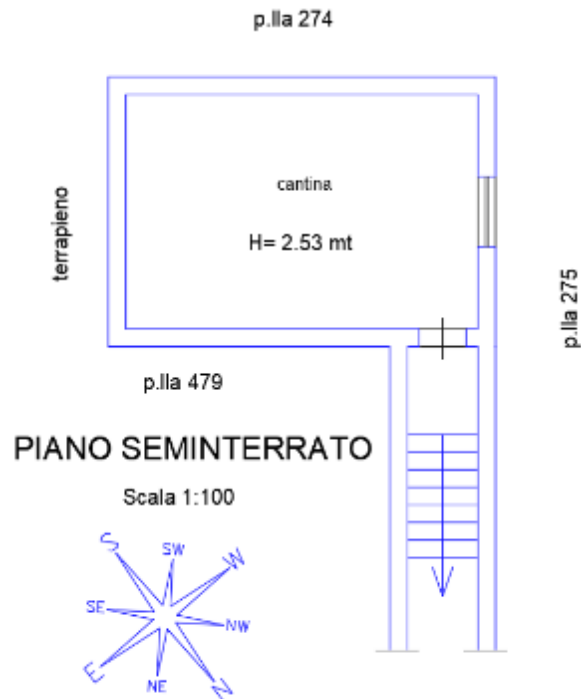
LOTTO 2 - planimetria appartamento piano interrato
